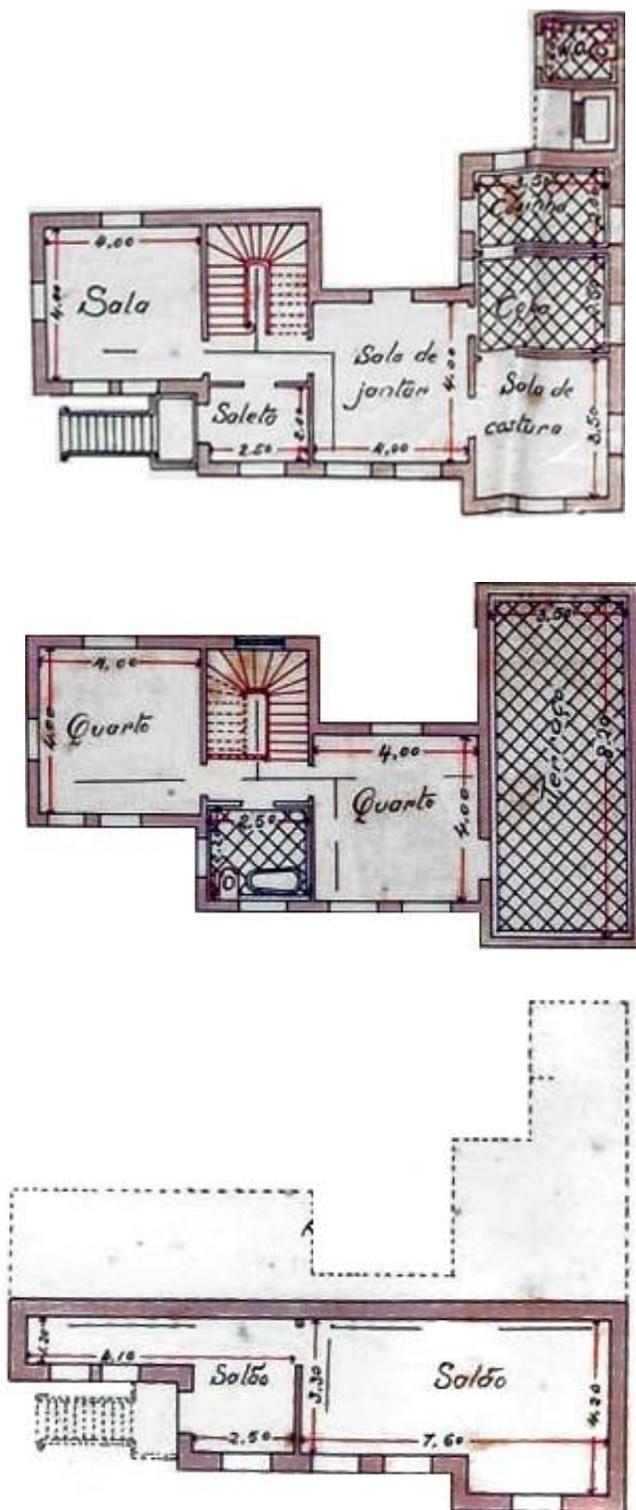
, 228 e 228: Planta baixa do pavimento de acesso, do pavimento superior e do porão.
